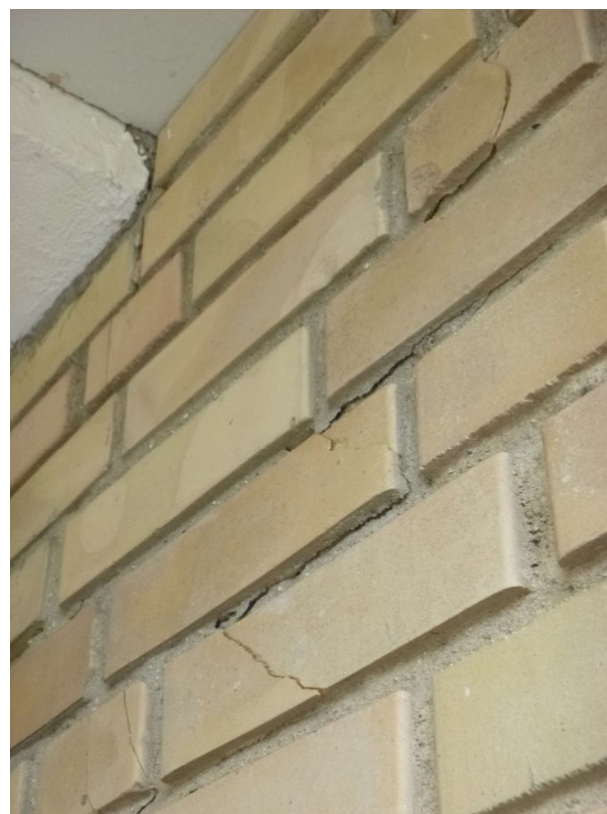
Mursten er knækket under altangangselementet nær trappeopgangen. (Punkt 1)
